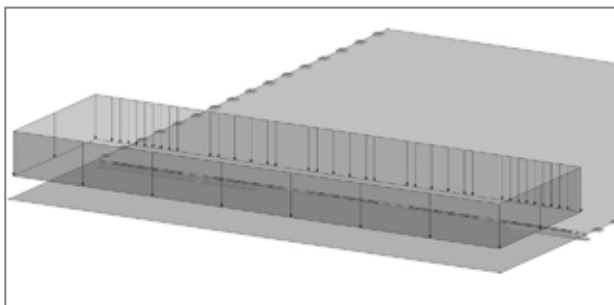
Schöck Isokorb® T type K-E, K-T: 3D view of the load on the balcony; left slab support articulated, right restrained
